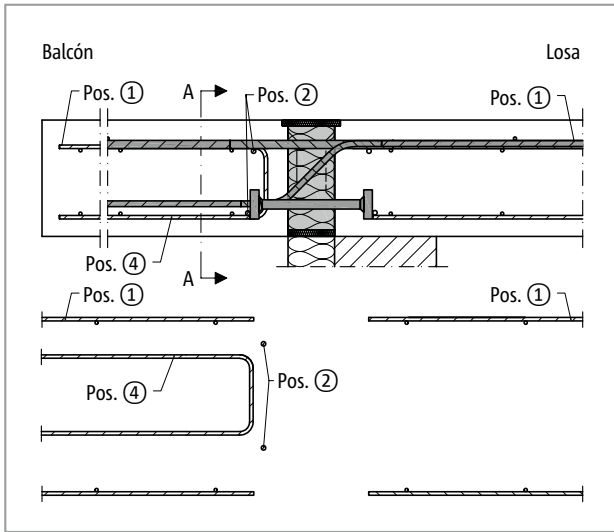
Schöck Isokorb® T tipo K-M12: Armadura in situ en caso de apoyo directo
